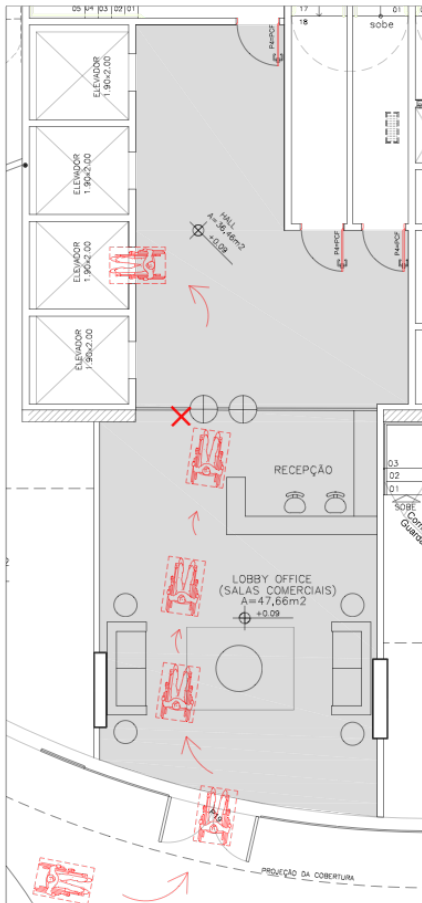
Barreira encontrada na entrada do pavimento térreo. Fonte: autora.
